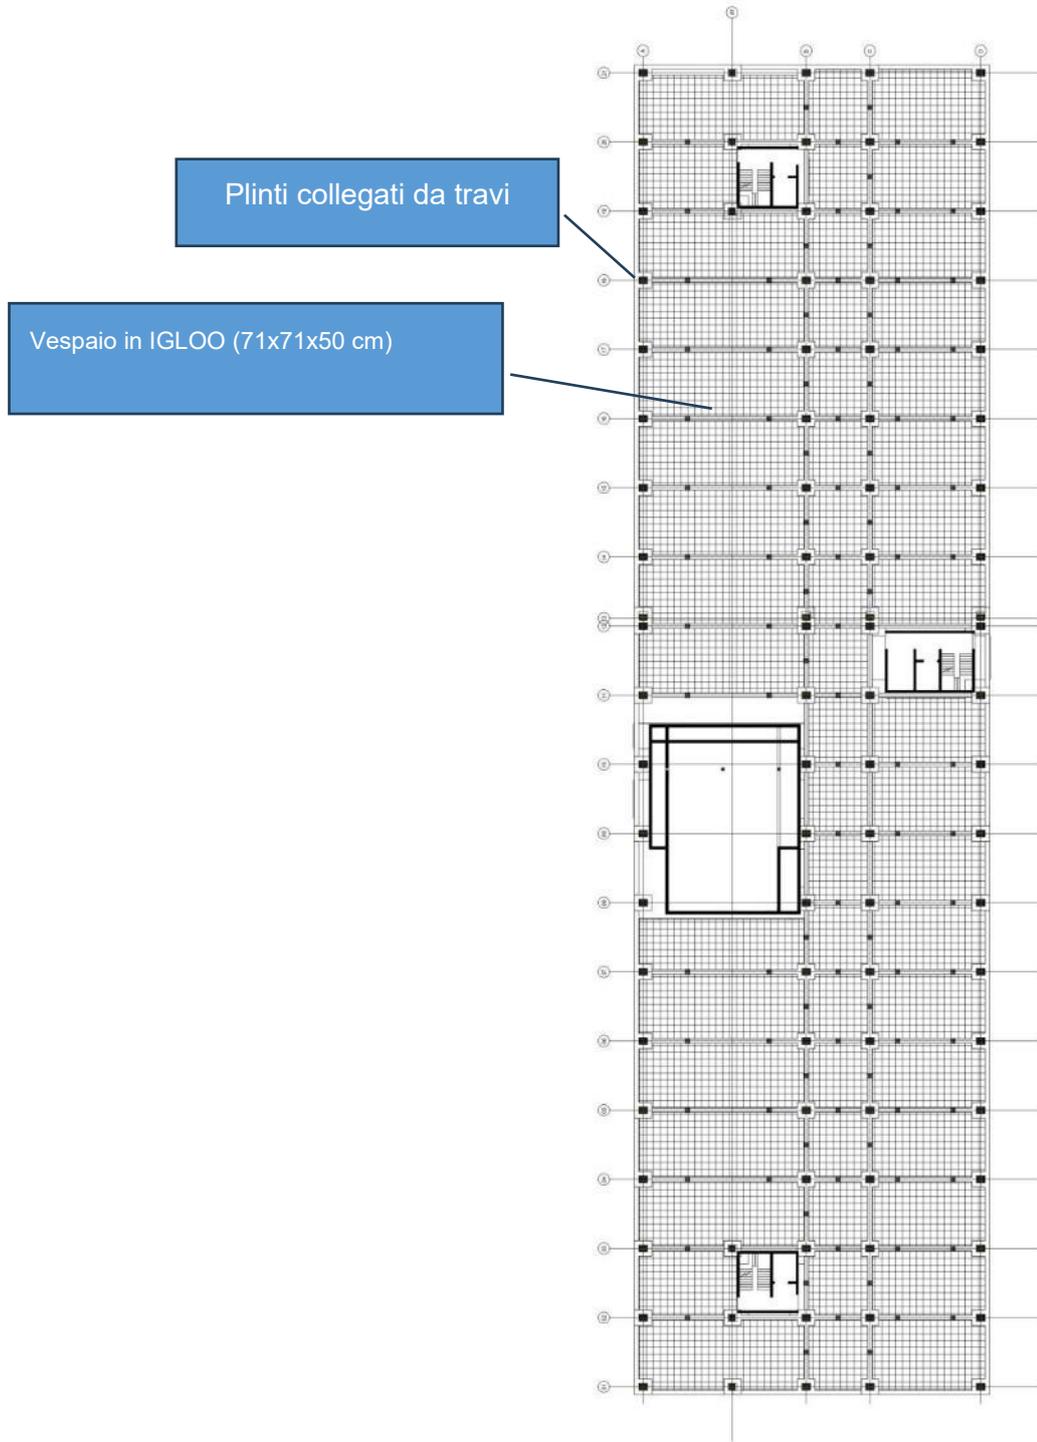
Pianta delle fondazioni e del vespaio aerato
